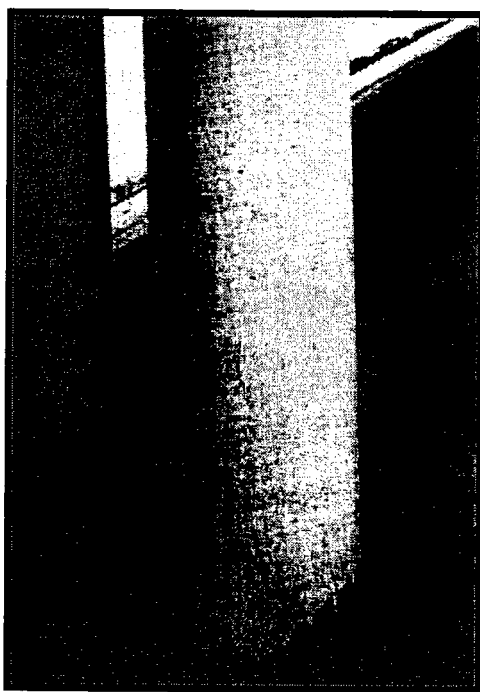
鋼筋混凝土柱發生鹼質與粒料反應之內部徵候⁽¹⁹⁾
